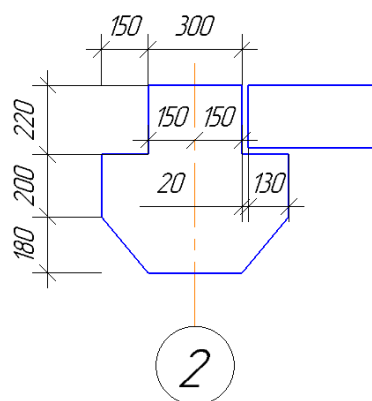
Схема узла опирания панели на полку ригеля крестового сечения.
